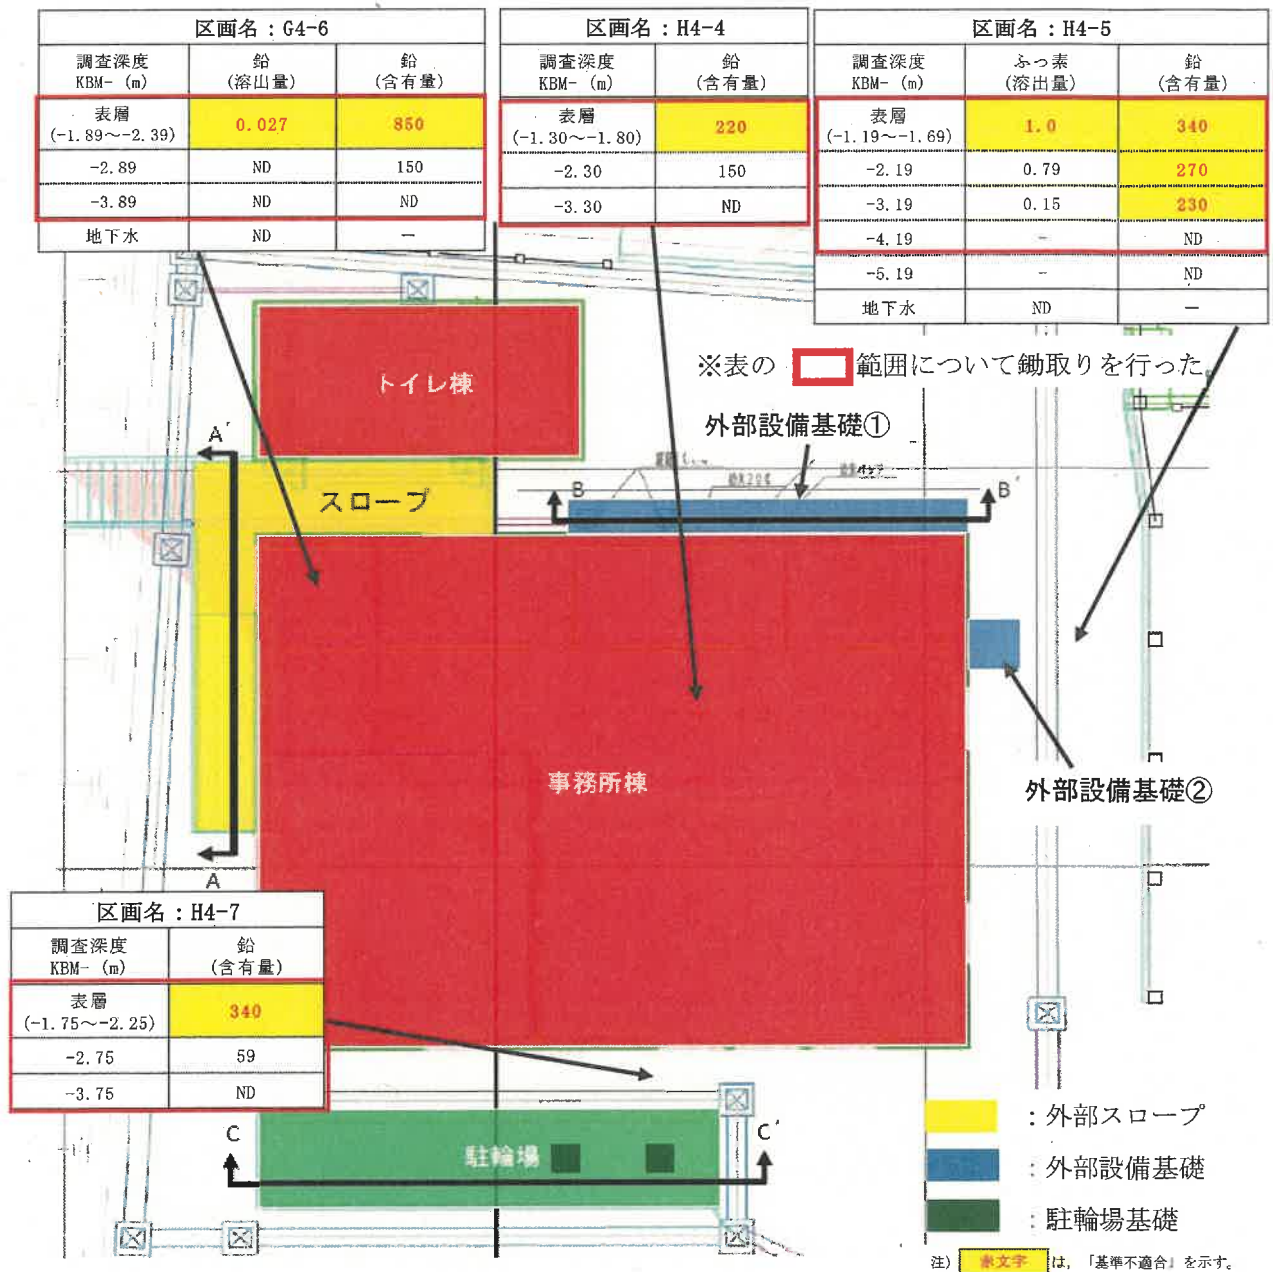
土地の形質の変更の施工方法を明らかにした平面図（外構躯体工事）
